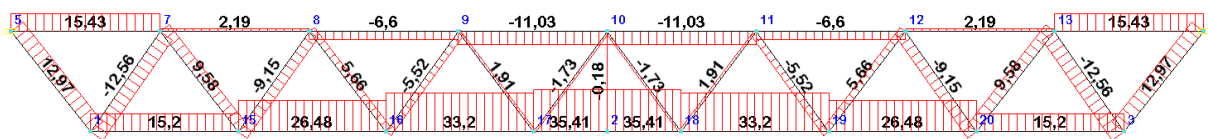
Эпюры усилий в элементах фермы от нагрузки 1 кН/м²
